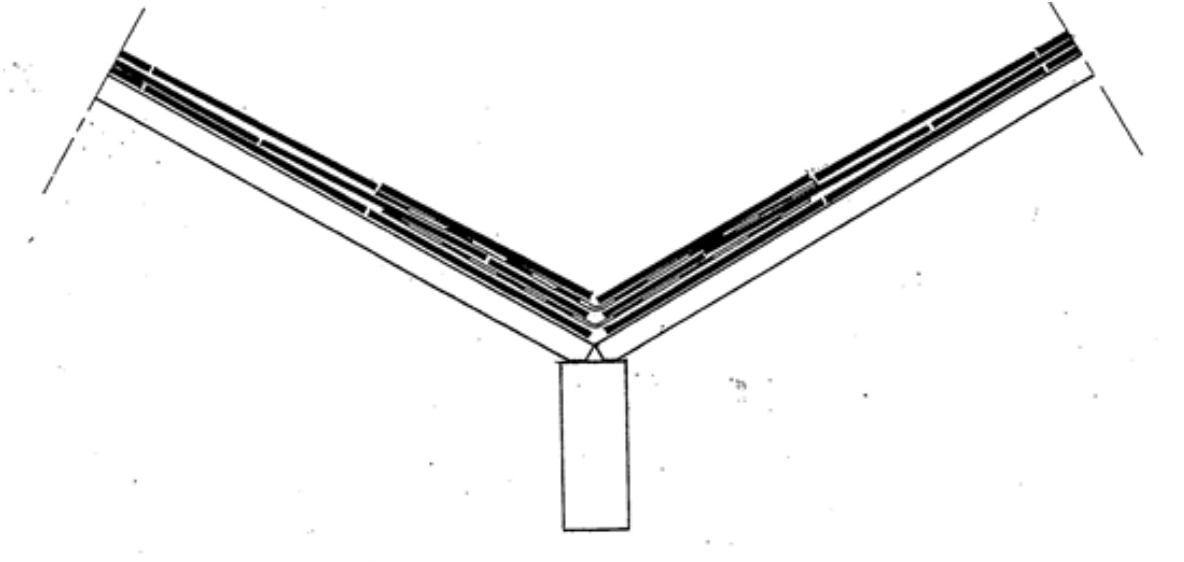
E: Aansluiting kopgevel met hardstenen afdekker
